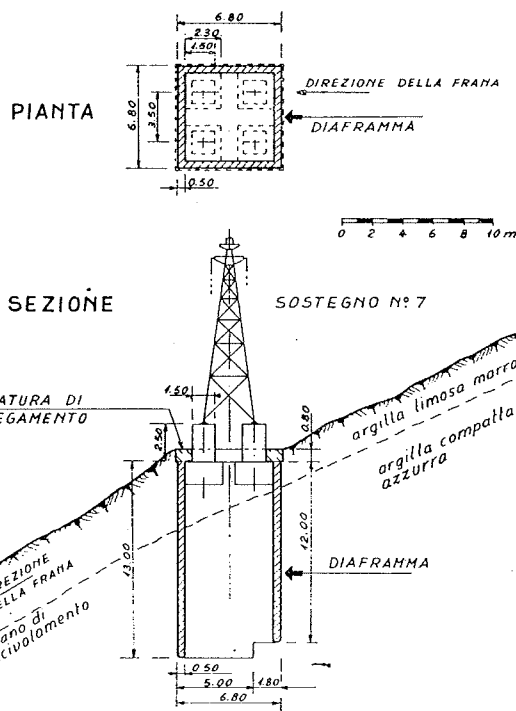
Diaframma di protezione sviluppatosi perifericamente alle fondazioni.
